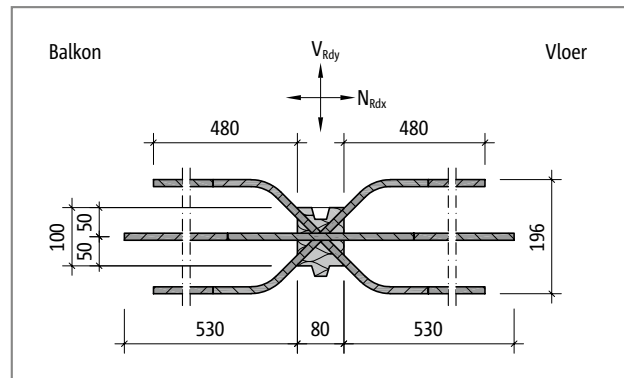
Schöck Isokorb® T type H-VV1-NN1: Zijaanzicht
